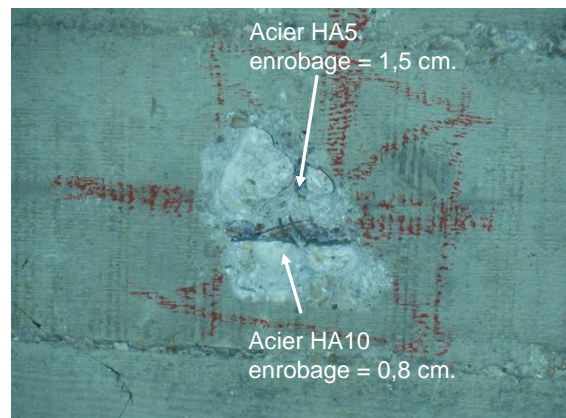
ouverture sur aciers en sous-face de la dalle
